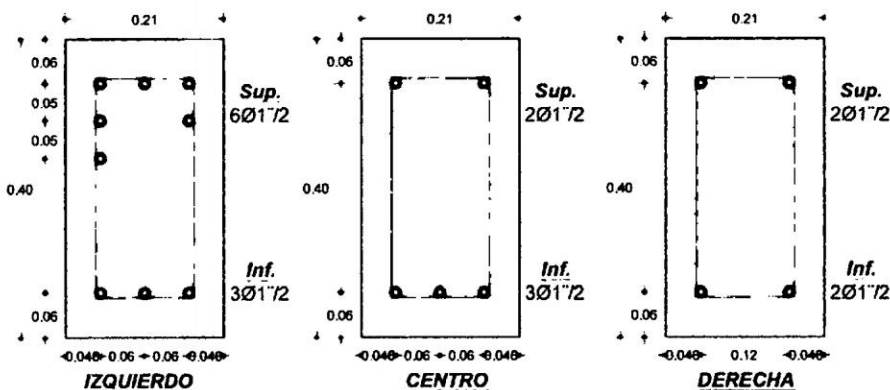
Sección típicas con refuerzo Final de la viga V102
